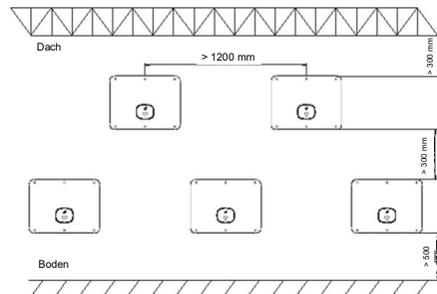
Montageabmessungen für einen Wechselrichter
